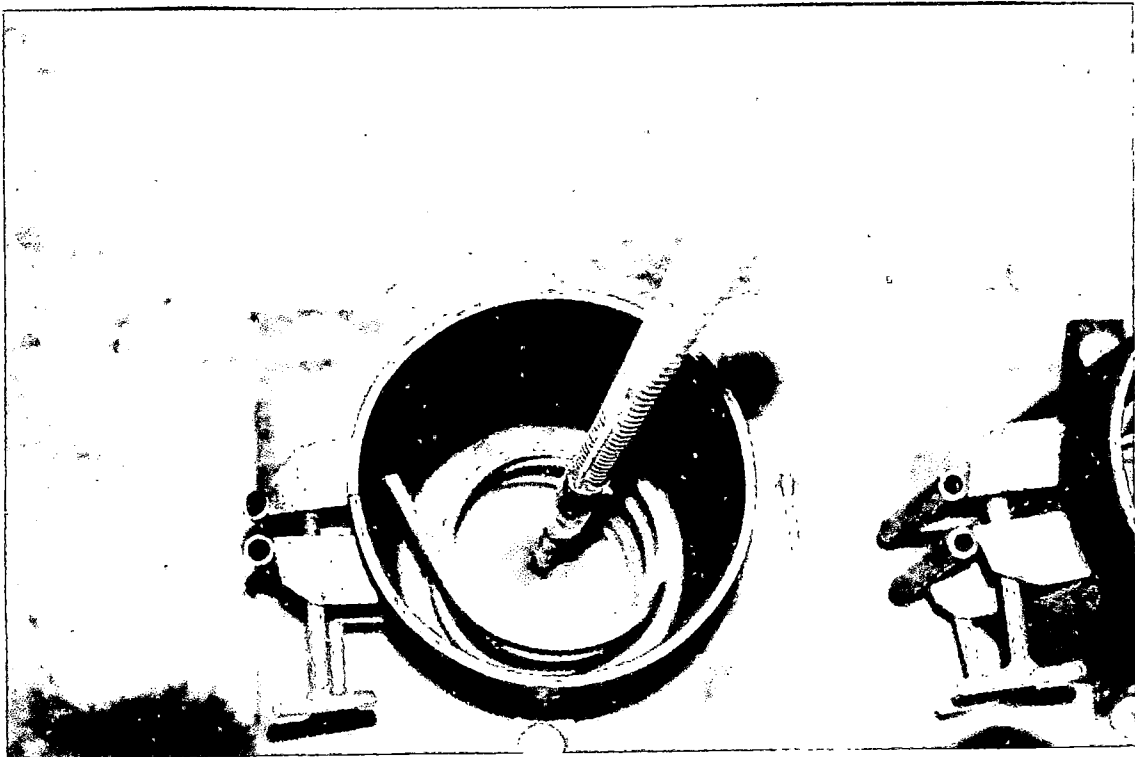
Muestra la armadura en espiral y la longitud de anclaje en una probeta.
